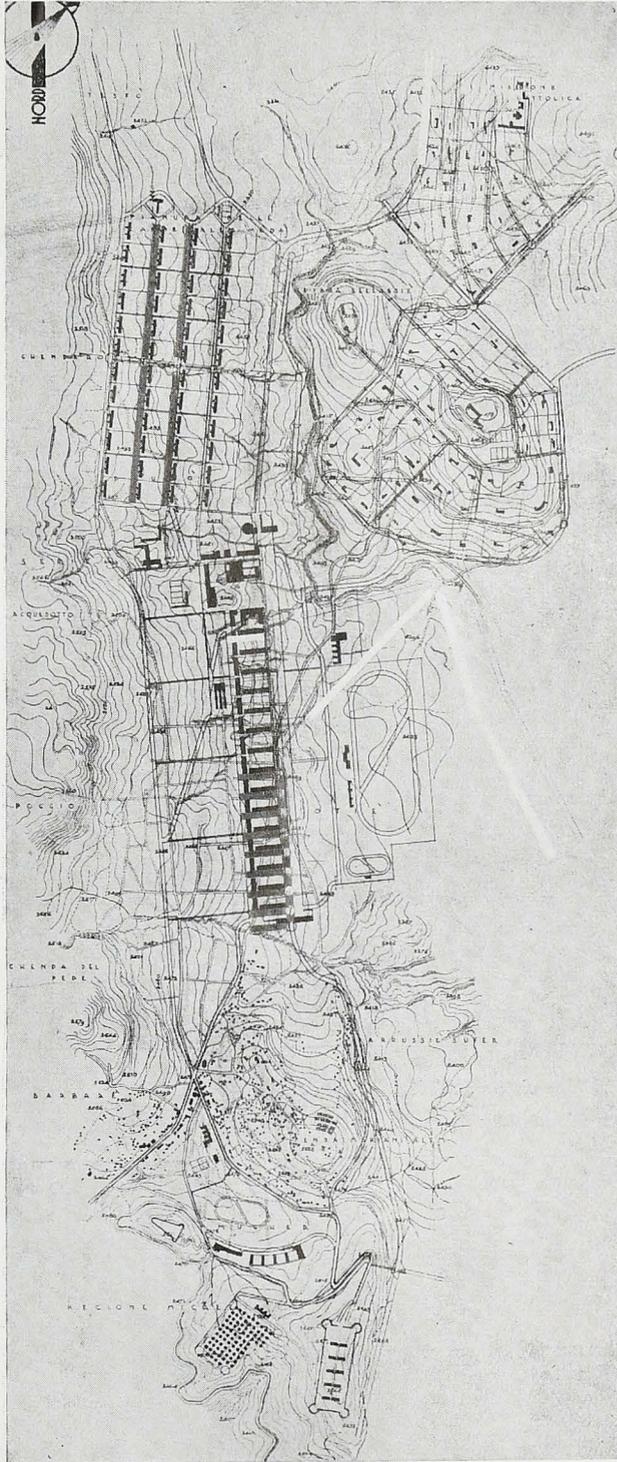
DESSIÈ — Planimetria generale dello schema urbanistico di regolazione.
